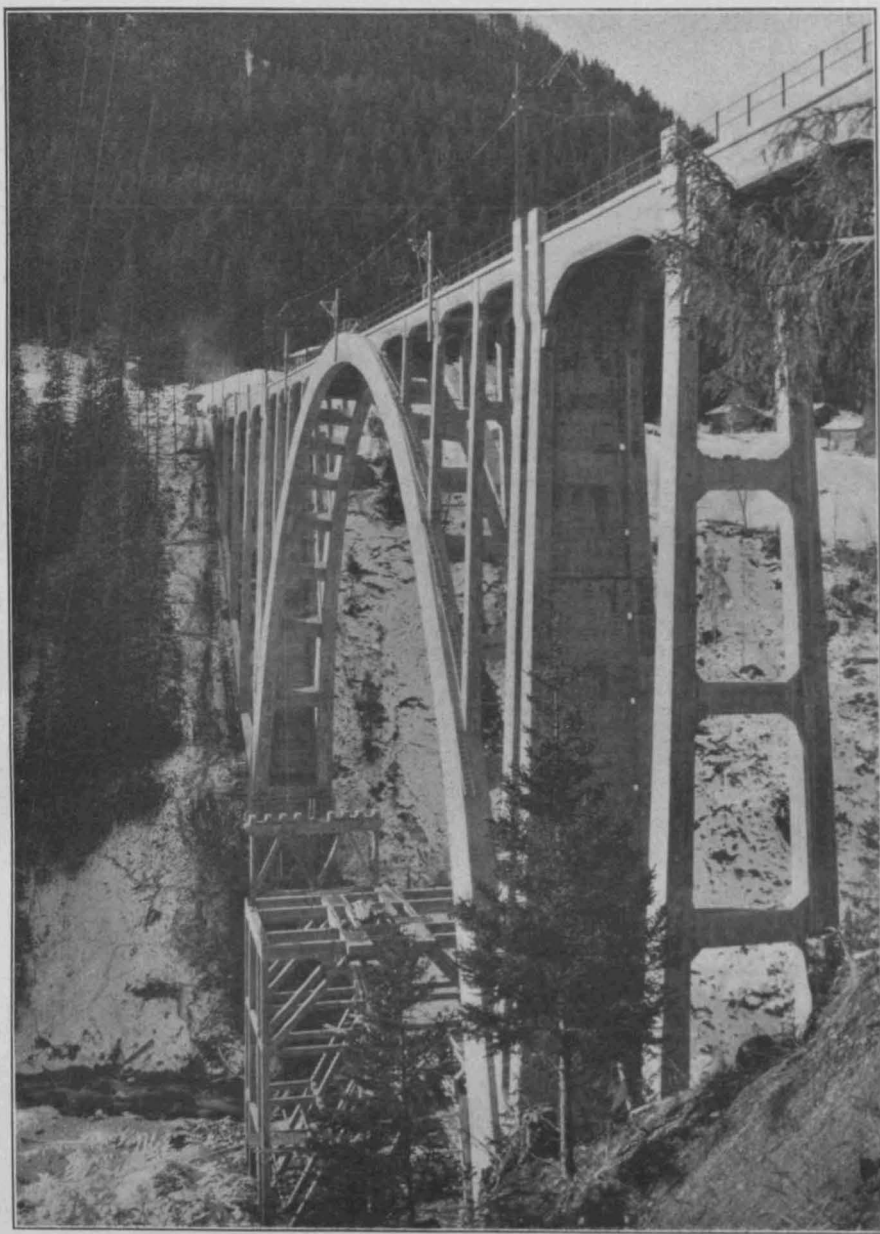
Langwieser-Viadukt. Lehrgerüst bis auf die Eisenbeton-Unterbauten des Mittelgerüsts beseitigt. Phot. Aufnahme von Ant. Reinhardt in Chur.
